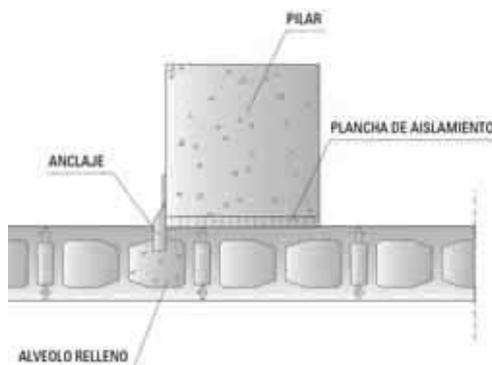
Anclaje de fábrica a pilar de hormigón.
